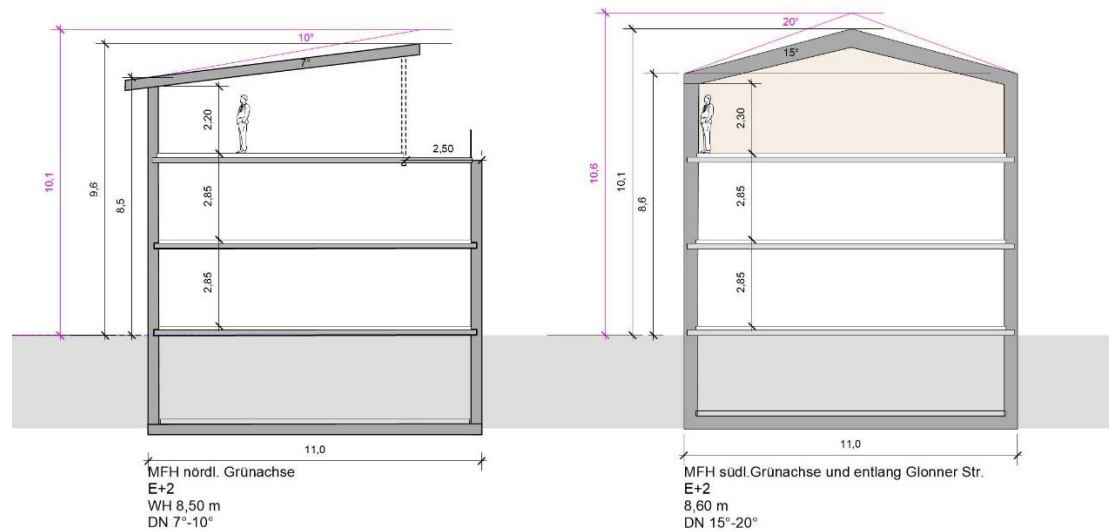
Gebäudetypen Geschosswohnungsbau im Plangebiet – Städtebaulicher Entwurf, Stand 09.12.2025
